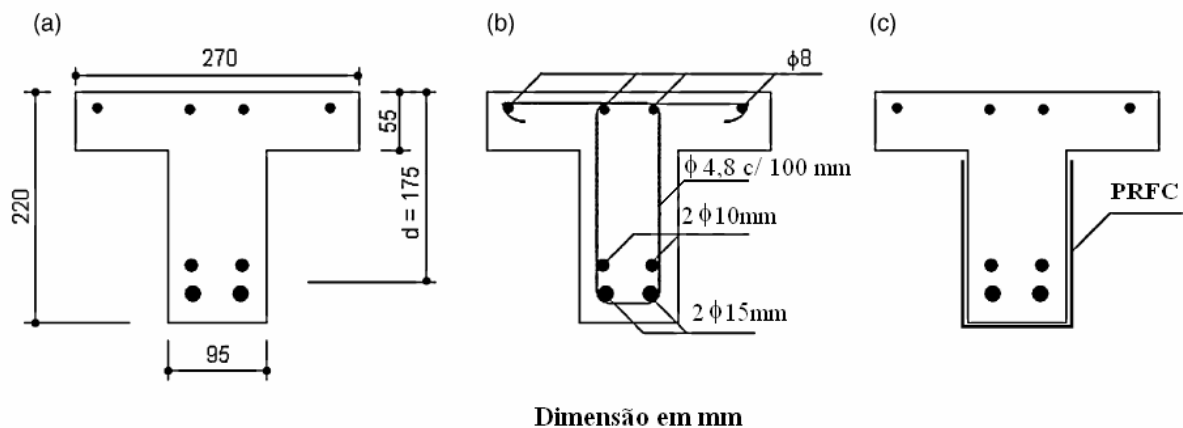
Detalhes das vigas ensaiadas: (a) seção transversal sem estribos (b) seção transversal com estribos (c) seção transversal com PRFC (CHAALLAL *et al.*, 2005)
